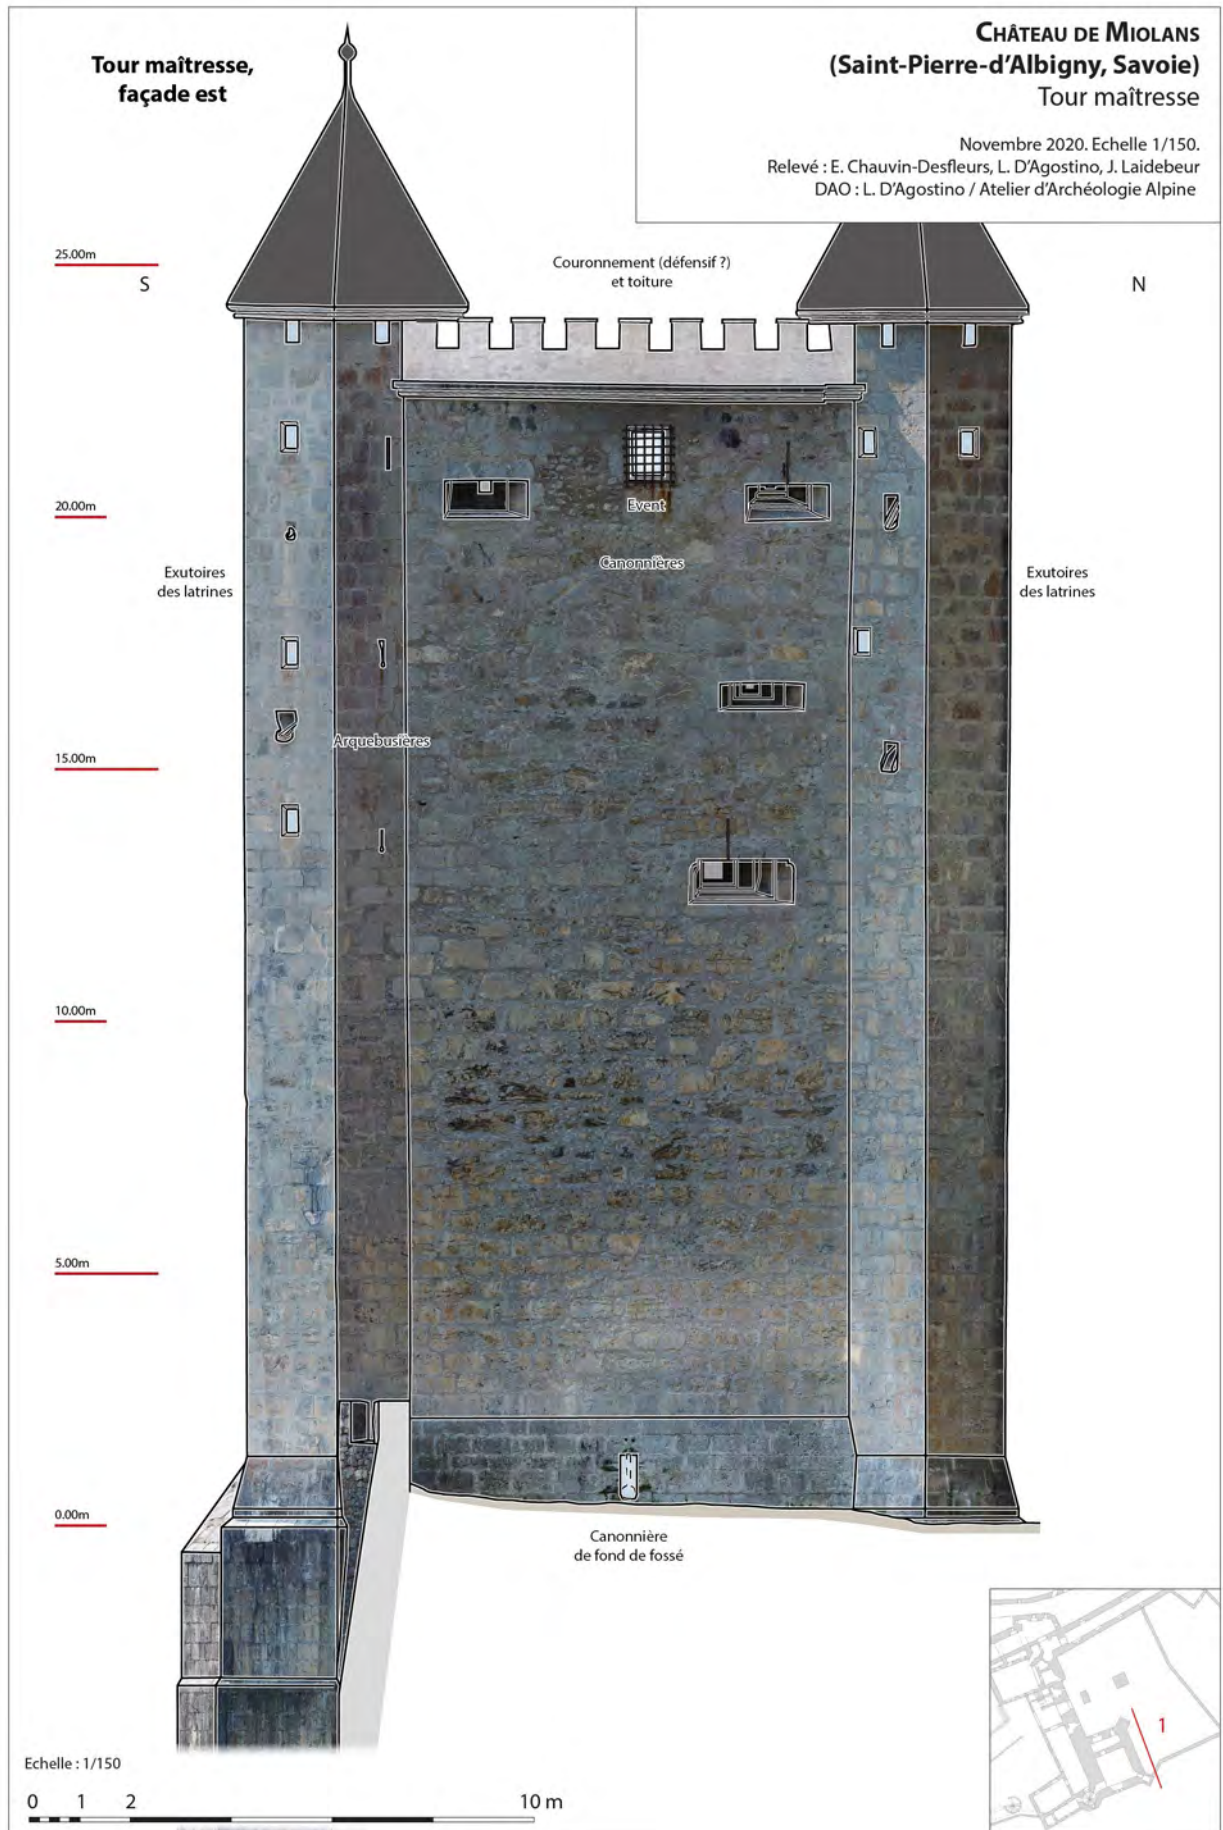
Château de Miolans. Tour maîtresse, façade est. Doc : L. D'Agostino
